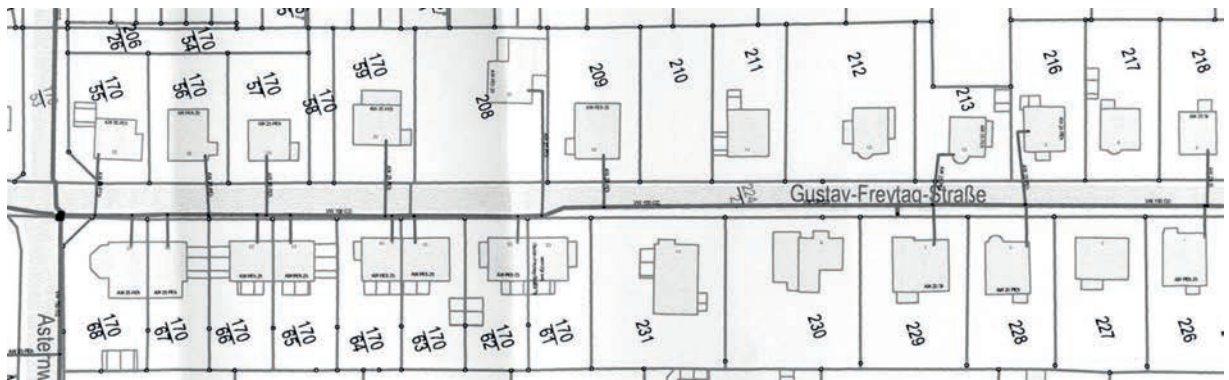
Einzelhausbebauung mit hoher Anschlussdichte
